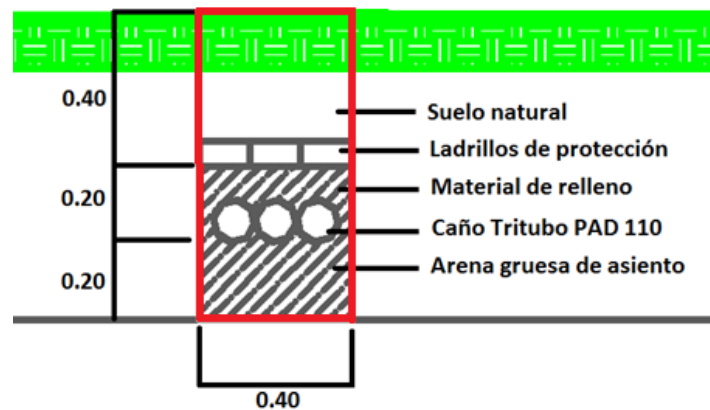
Sección transversal tipo de la excavación, utilizada para el cómputo de materiales
